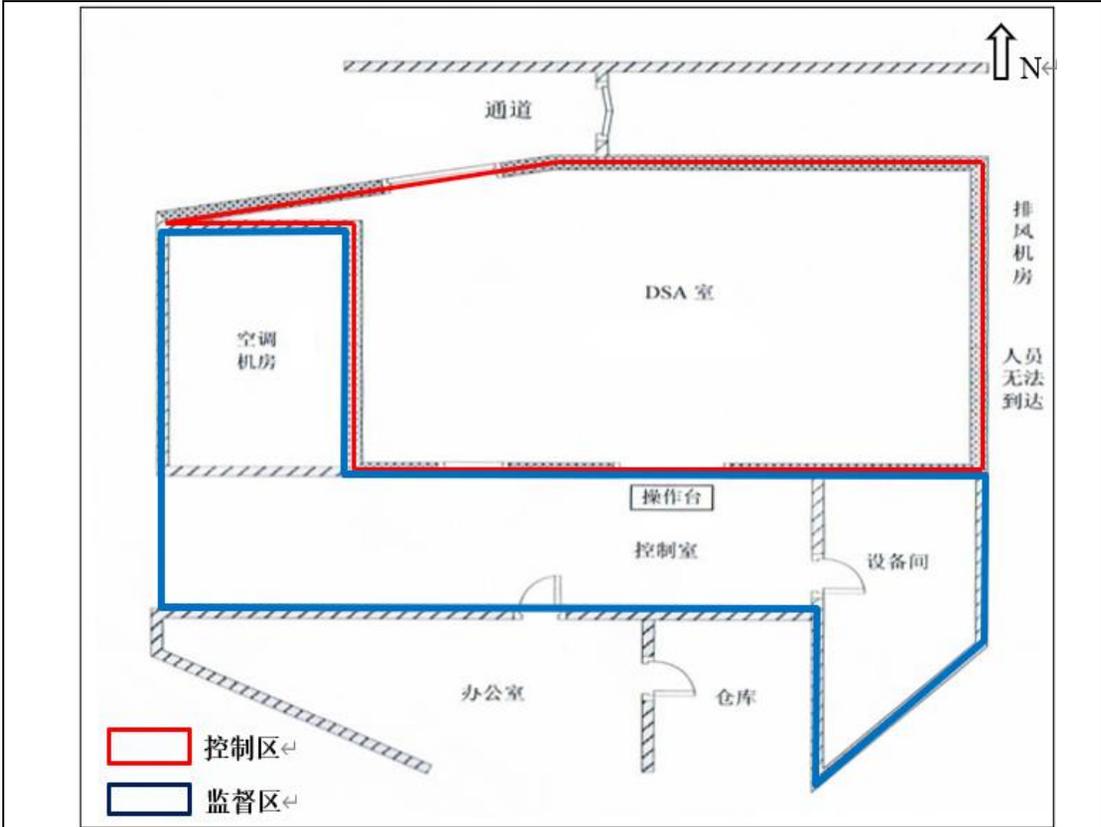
住院A楼地下一层DSA室平面布置及分区示意图
